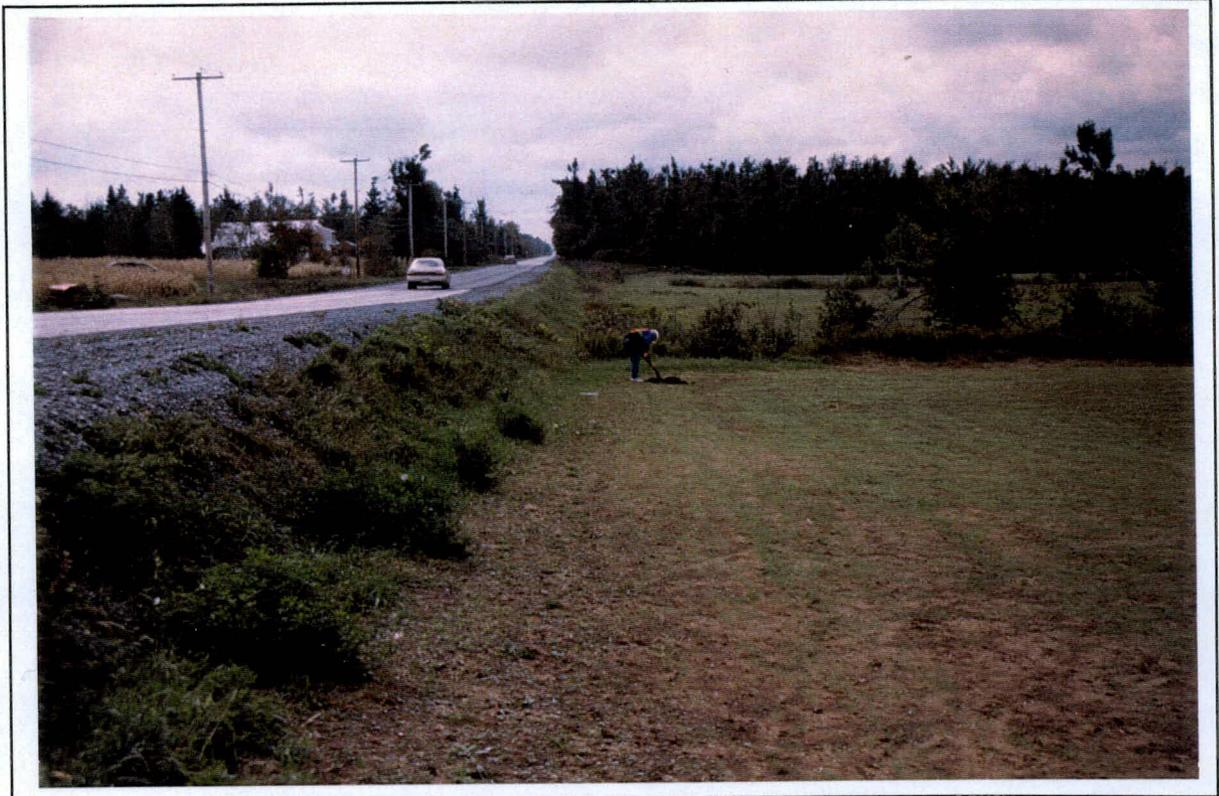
Projet 5373-9834, Route 235, secteur 1, portion nord-ouest. (SSO)
